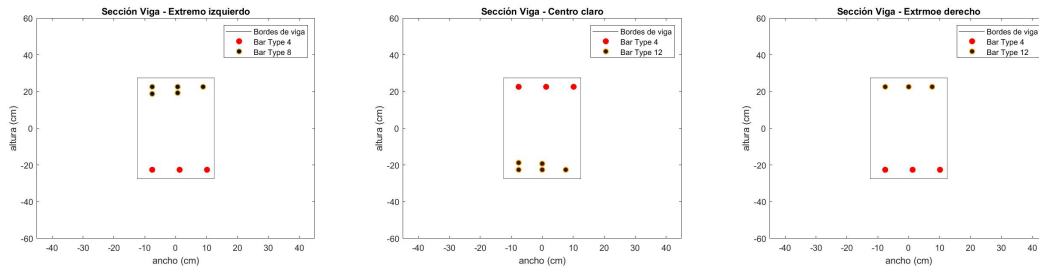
Secciones del modelo estructural 01: (Izq) Sección transversal en el extremo izquierdo de la viga con el refuerzo óptimo, (Cen) sección transversal al centro del claro de la viga con el refuerzo óptimo, (Der) sección transversal al extremo derecho de la viga con refuerzo óptimo.
